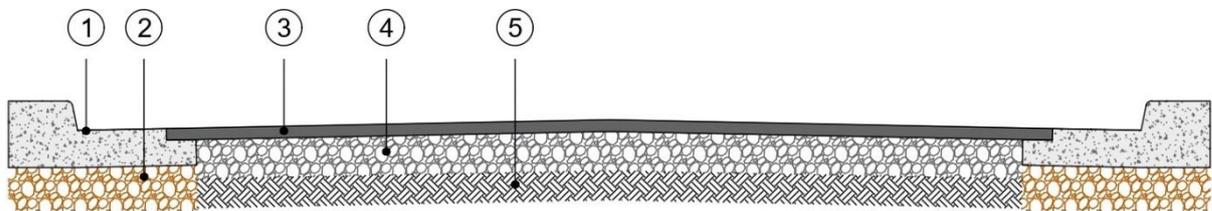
Anteproyecto vial: Paquete estructural seleccionado.
